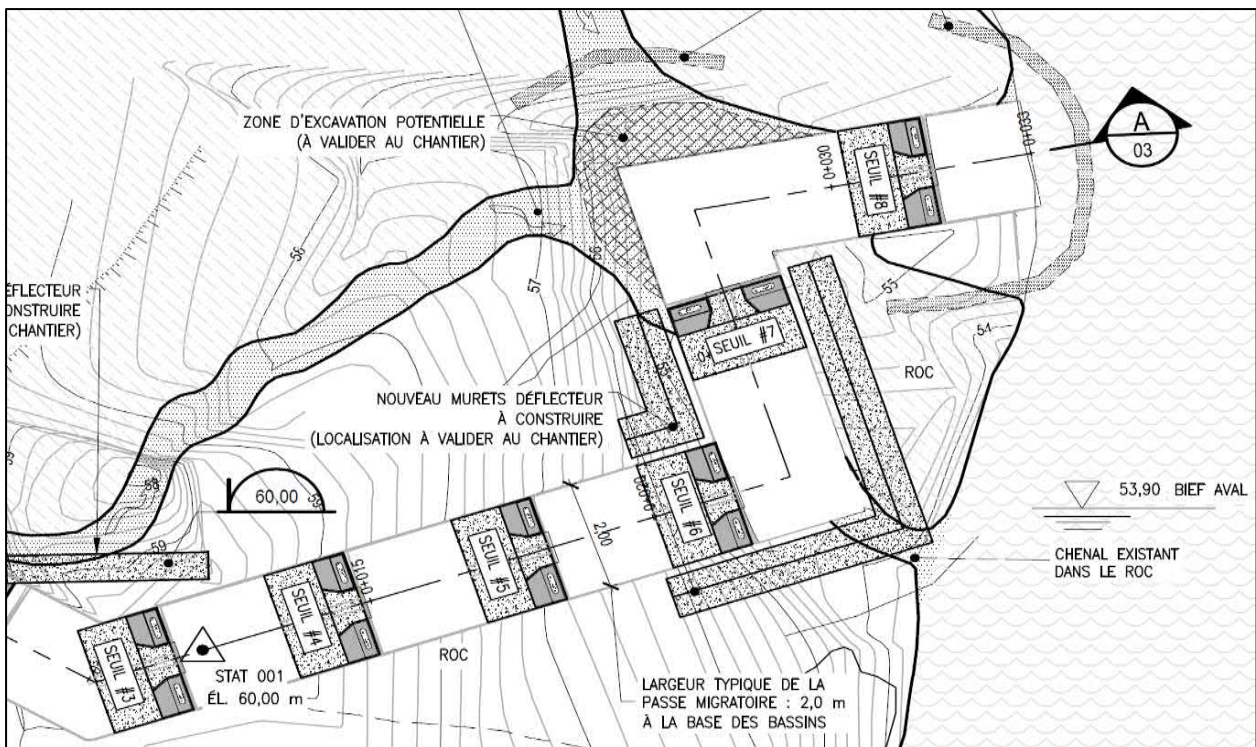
Extrait de plan – Vue en plan – Modification de la sortie de la passe
